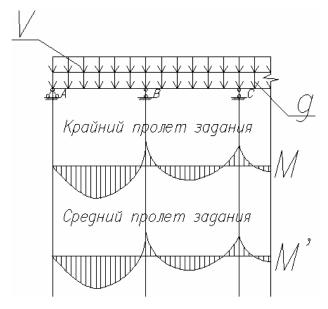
Эпюры моментов в крайнем и средних пролетах здания
